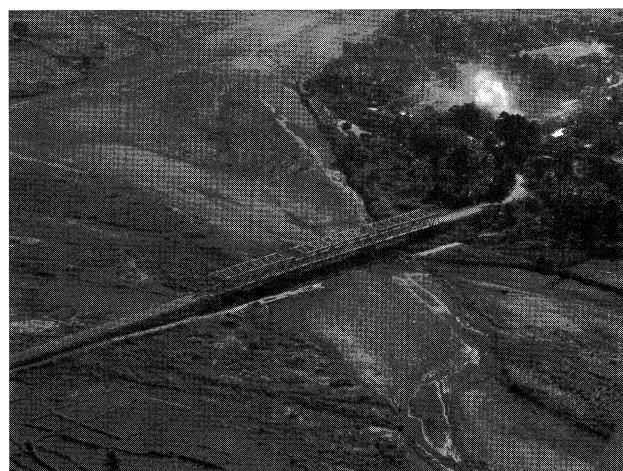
Laga 橋 (インドネシアン・トラス・タイプ) (A 01)
